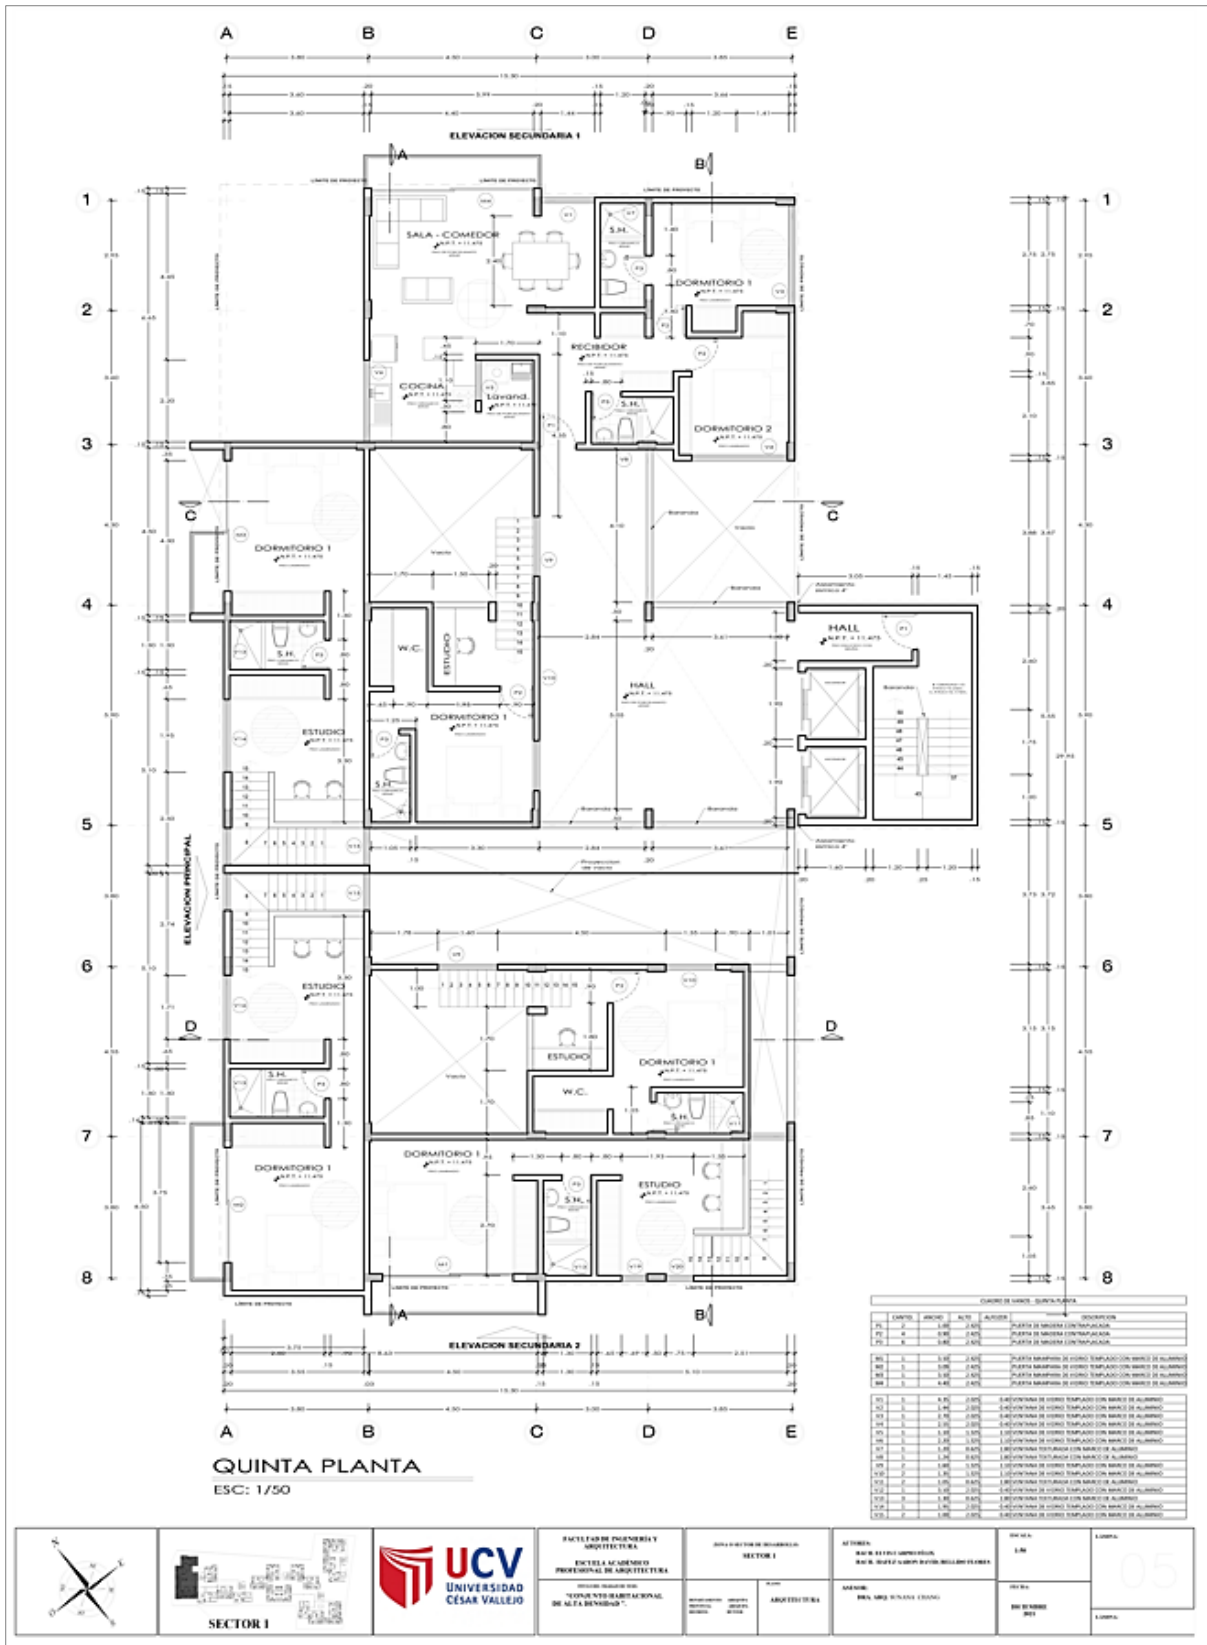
Planos de Arquitectura – 05 - Bloque 1 – Quinto Nivel
